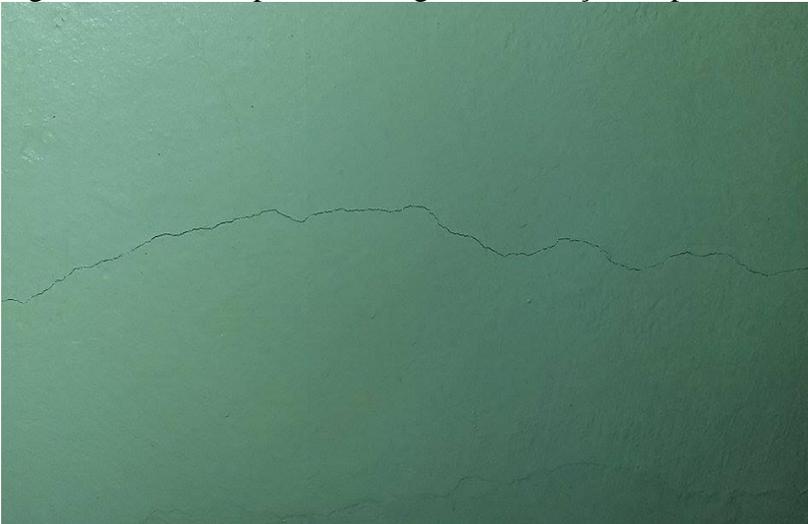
Fissura decorrente da amarração na circulação do pavimento 2.
